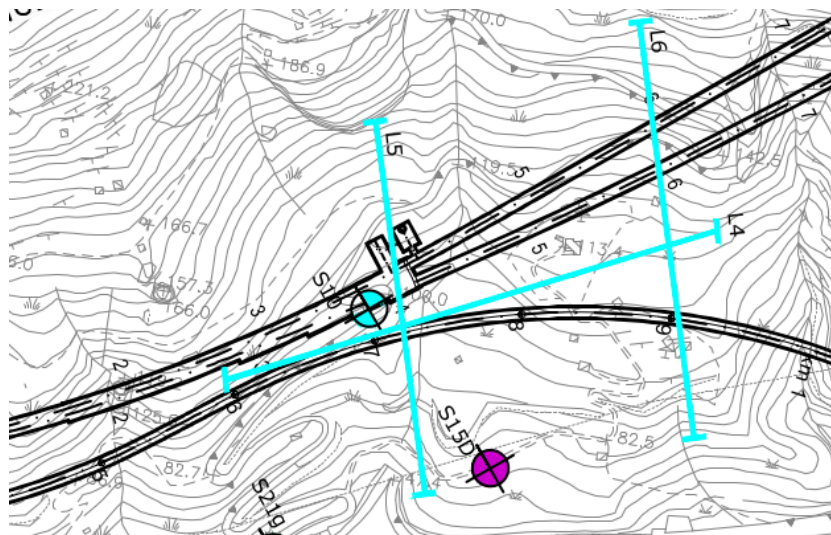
Planimetria con ubicazione del sondaggio S10.
